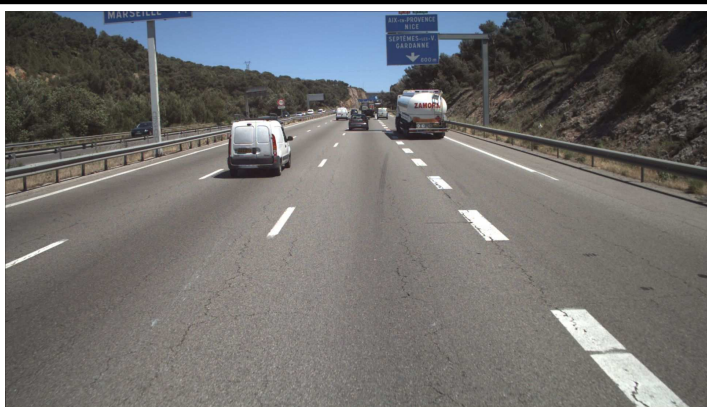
PR 269+819 sens plus - fissuration sur les trois voies
